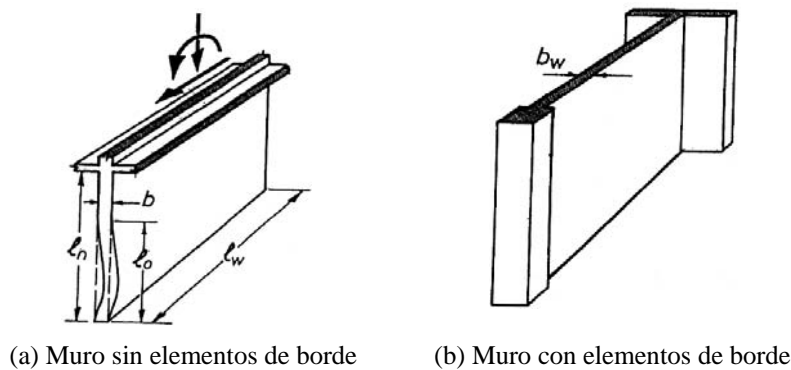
Configuraciones típicas de muros de hormigón armado [Paulay y Priestley, 1993]
